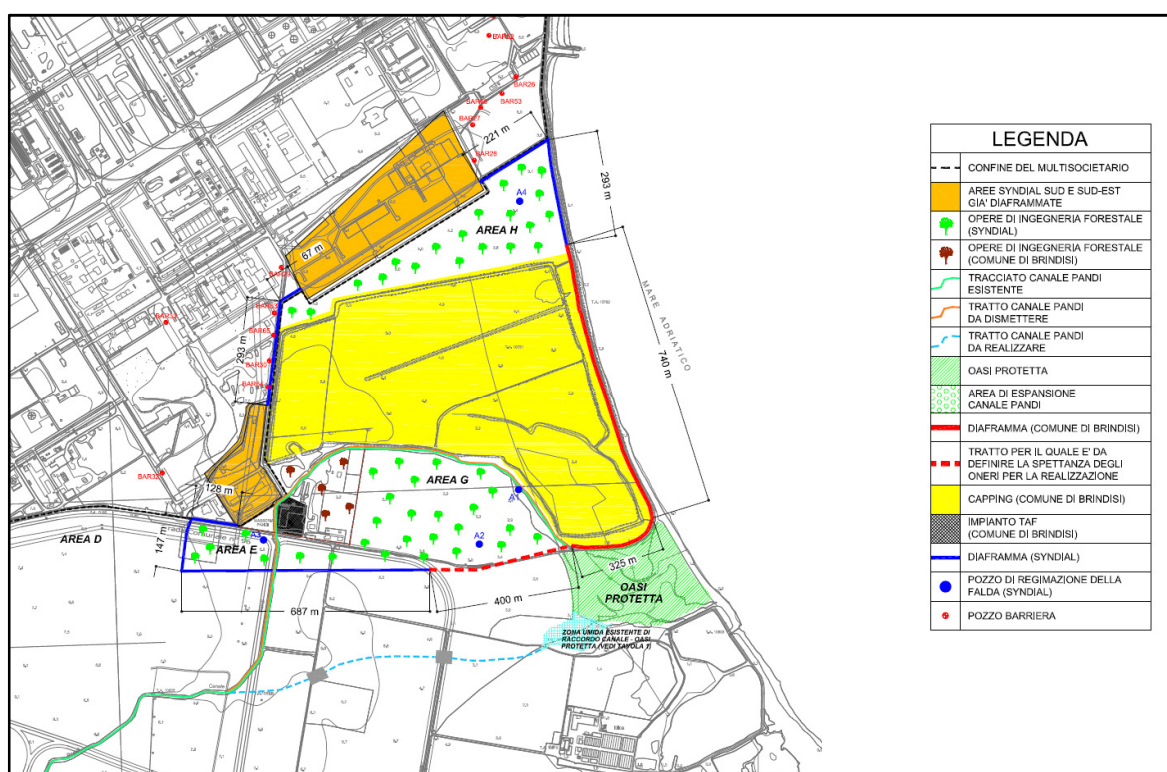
Tracciato del canale in progetto (azzurro).
